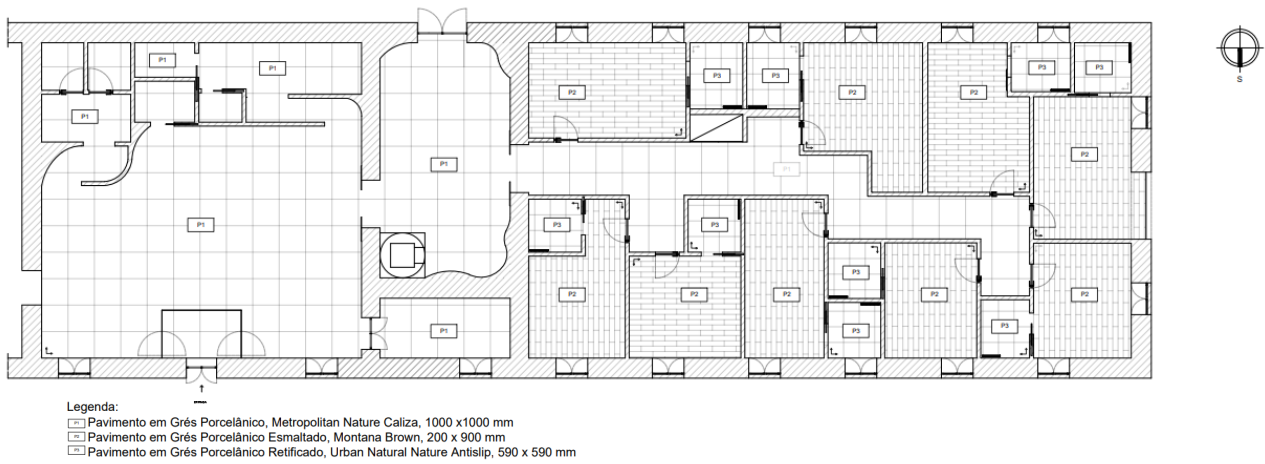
I - Planta de Pavimento, Piso 0, Alojamento Olive
